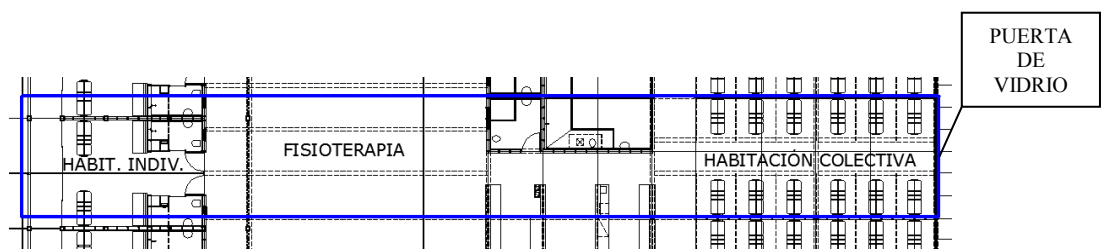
Modelo Sarah Rio - Planta baja de hospitalización (archivo del CTRS adaptado por la autora)
